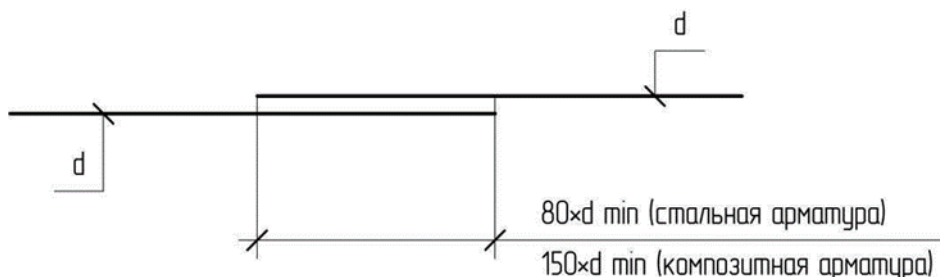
Схема расположения зон стыковки арматуры при горизонтальном армировании
